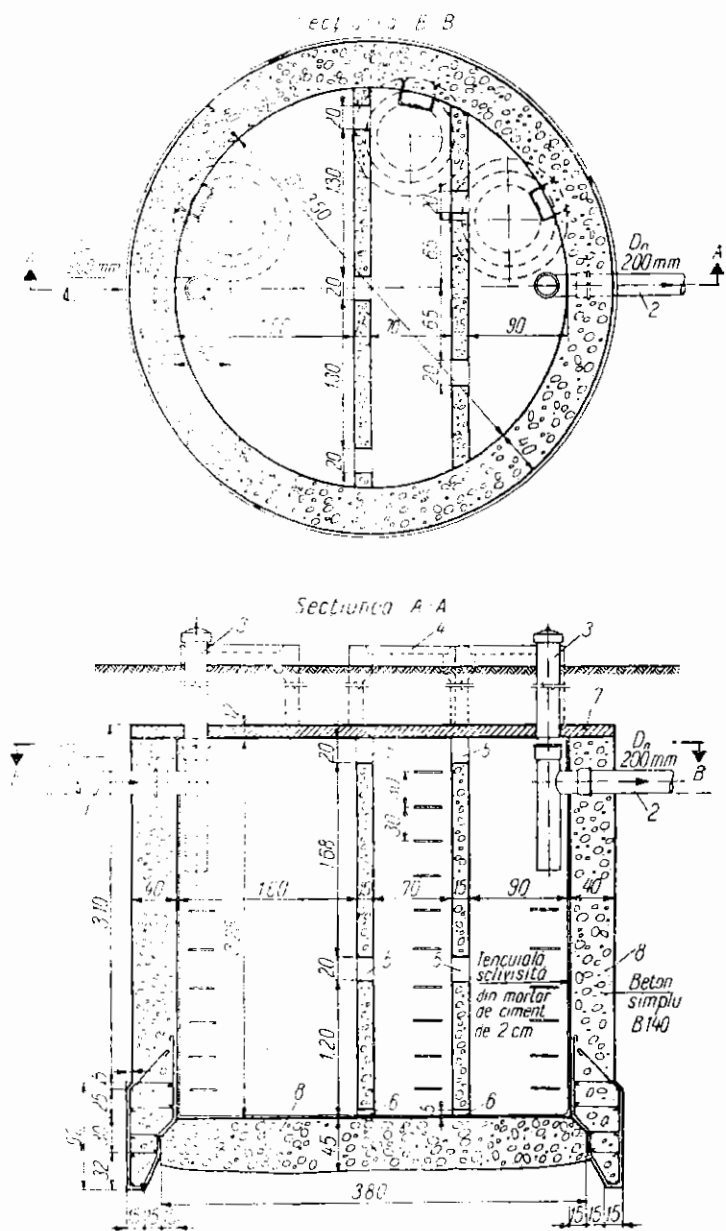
Fosă septică circulară, în cheson, din beton armat:
